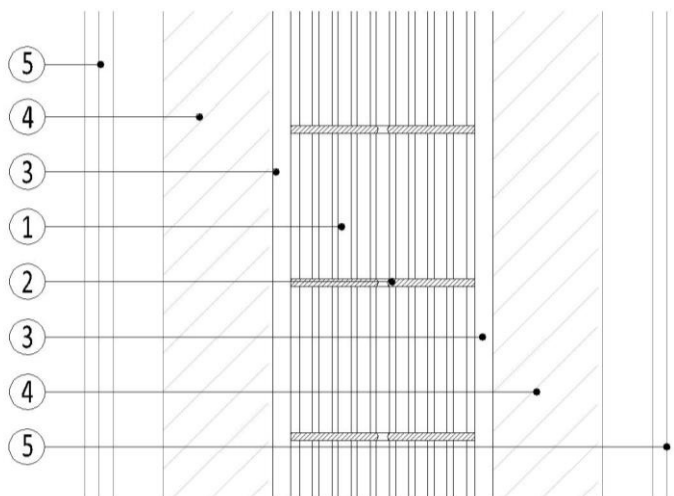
Partición interior en muro de carga, garaje con vivienda
